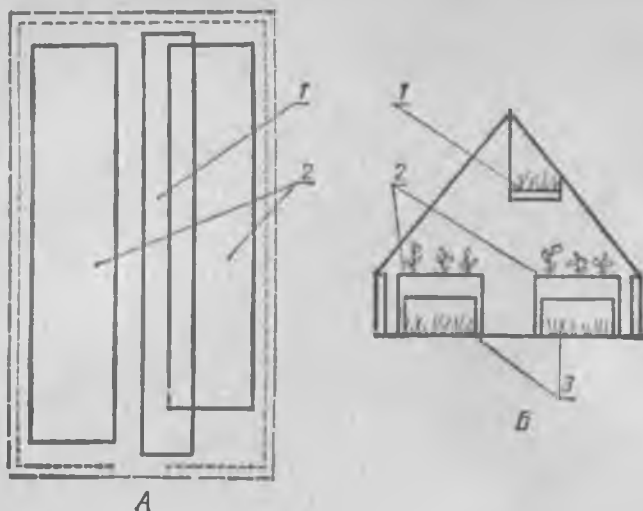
План (А) и поперечный разрез (Б) стеллажной теплицы:
